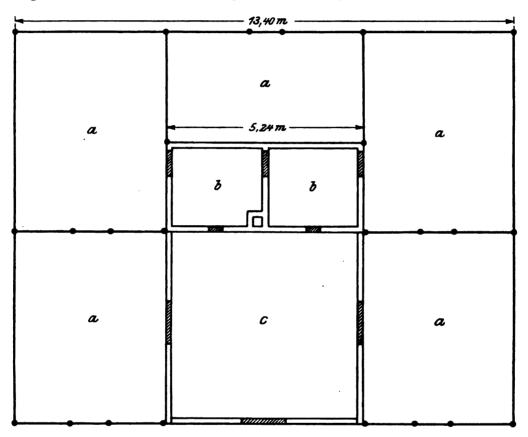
Grundriss der Flugkäfige. a) Flugkäfige, b) Winterkäfige, c) Arbeitsraum.
